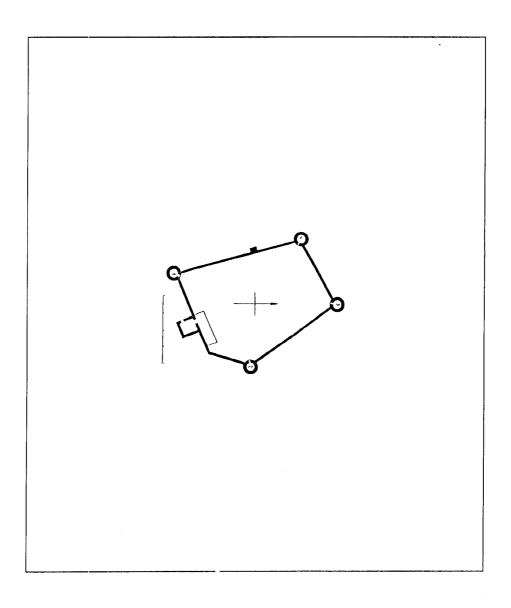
مسقط أفقي لأحد الأبراج في قلعة الأبراج السبعة بإستانبول (عن : إيفردى) .
